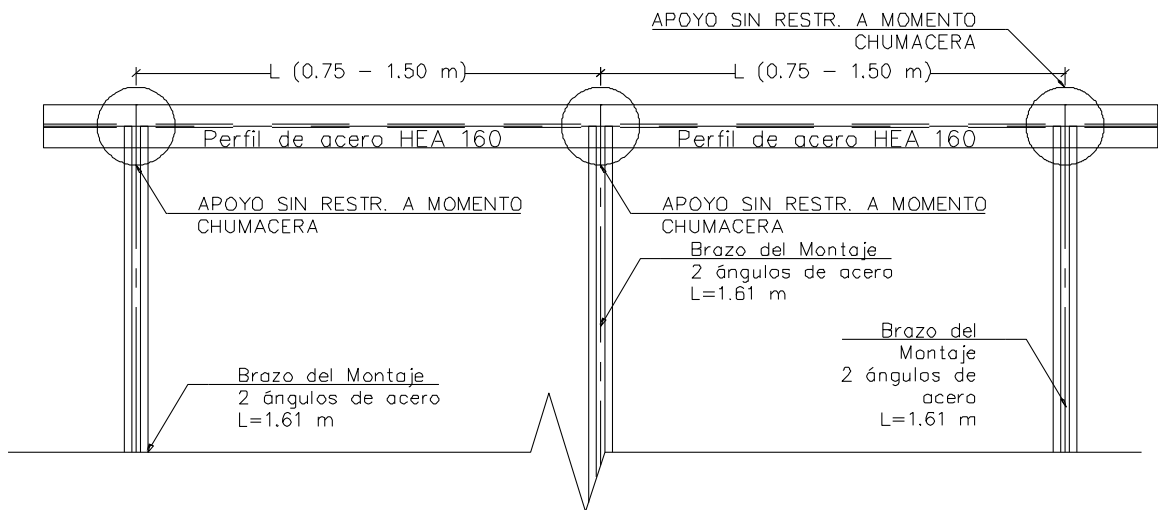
Esquema montaje de pruebas (Vista en planta)
